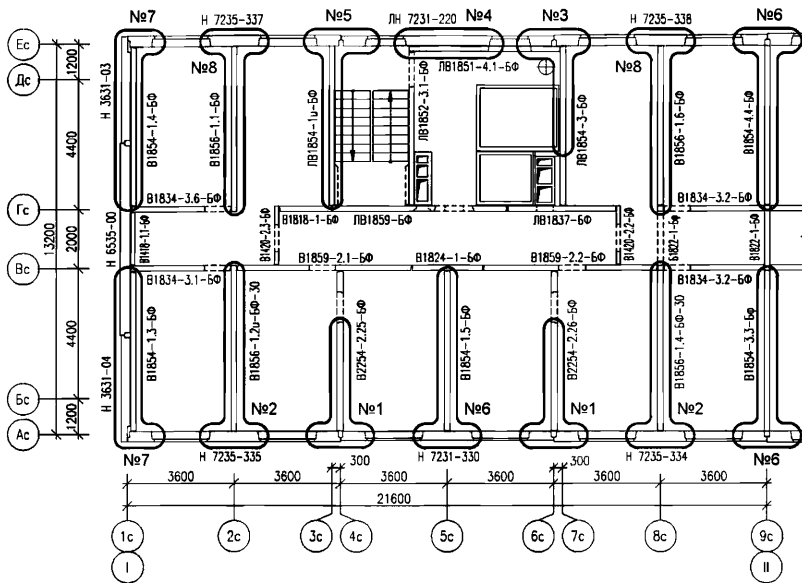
План расположения стен с указанием мест локальных разрушений
